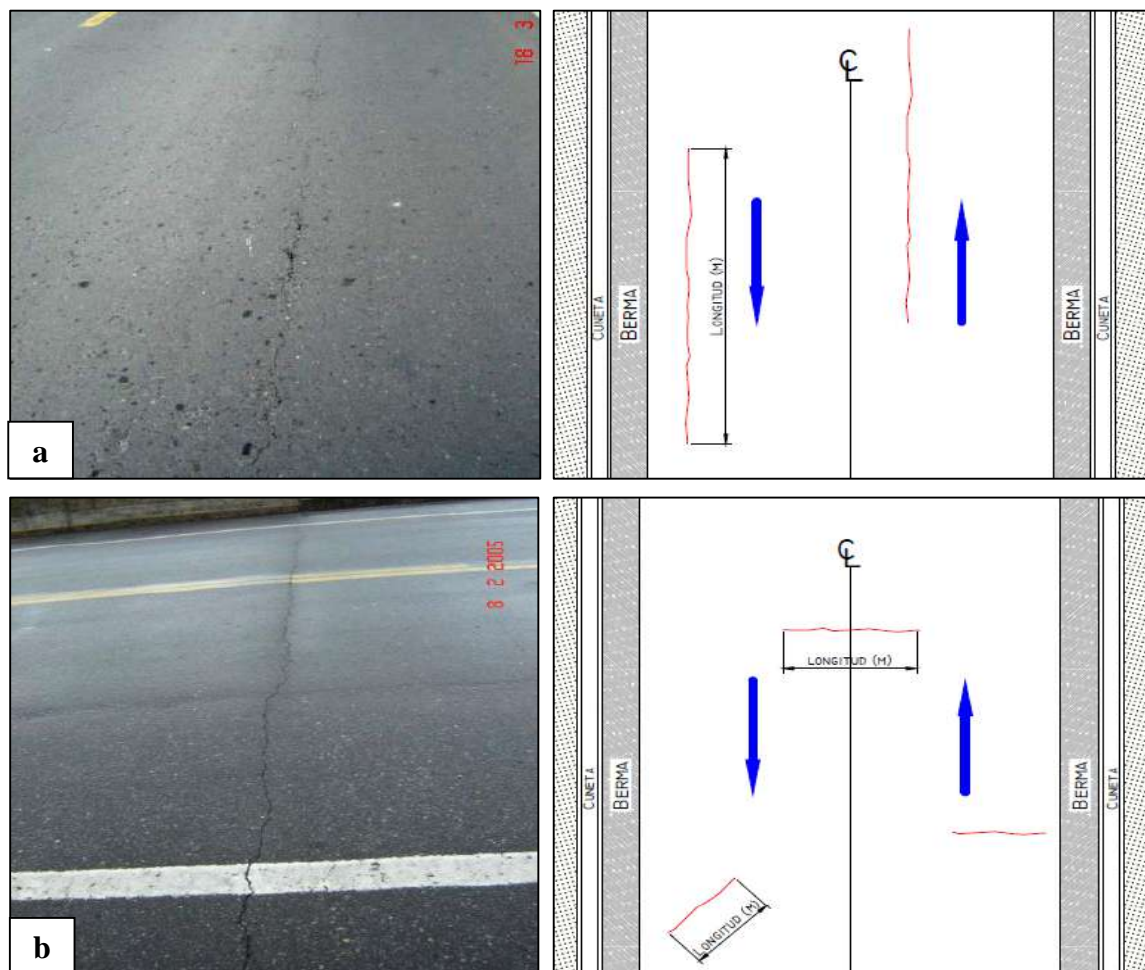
Fisuras longitudinales y transversales (unidad de medida: ml).
